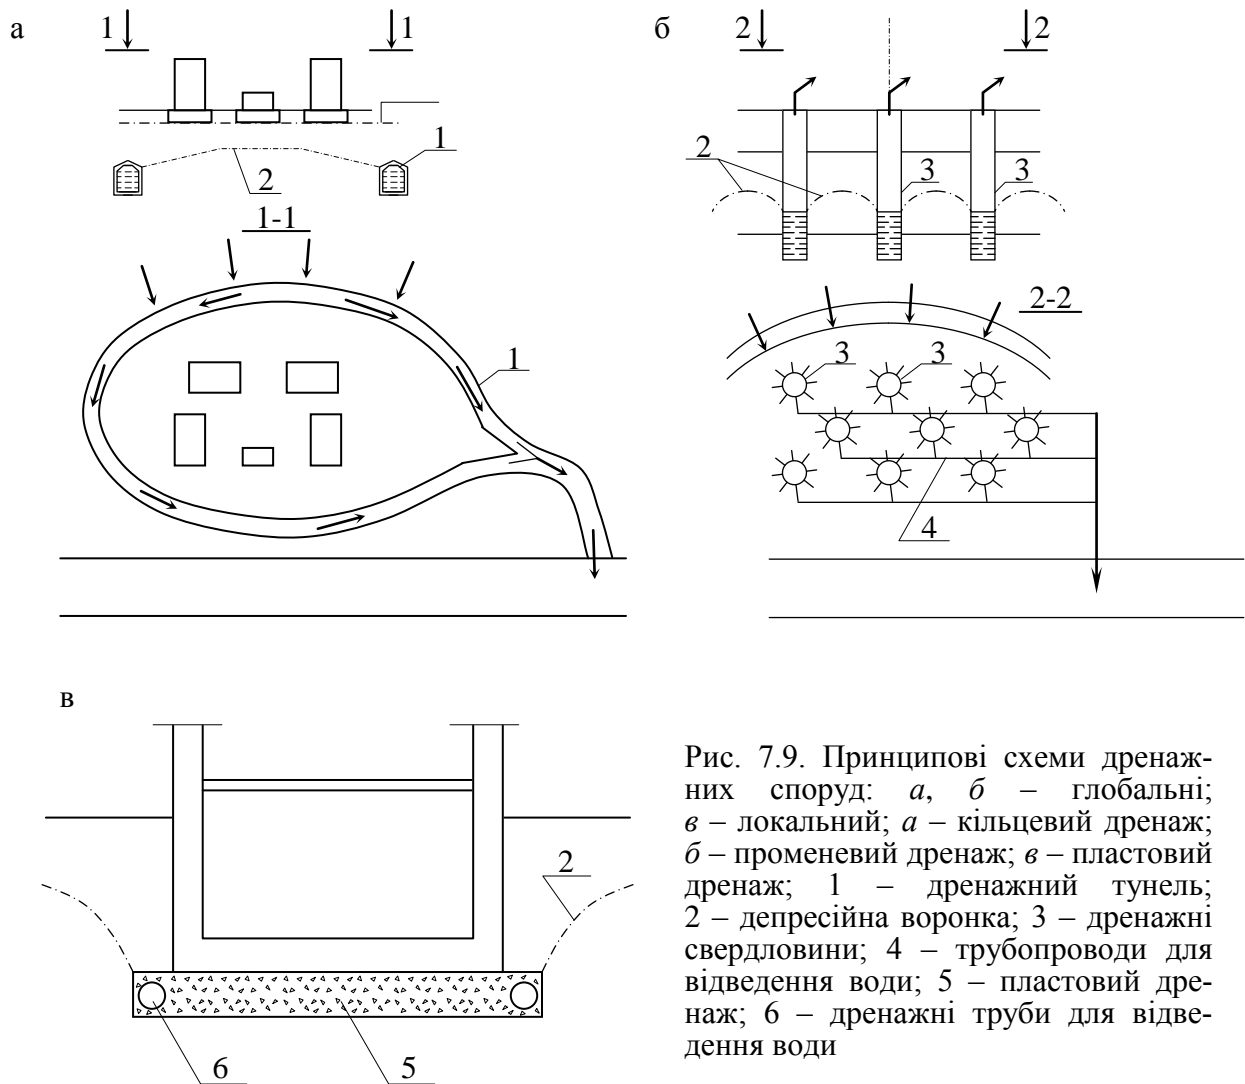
Принципові схеми дренажних споруд: а, б – глобальні; в – локальний; а – кільцевий дренаж; б – променевий дренаж; в – пластовий дренаж; 1 – дренажний тунель; 2 – депресійна воронка; 3 – дренажні свердловини; 4 – трубопроводи для відведення води; 5 – пластовий дренаж; 6 – дренажні труби для відведення води
